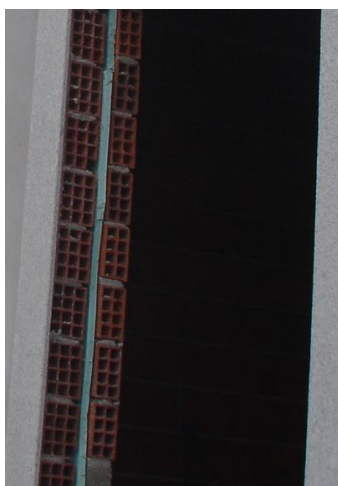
Pormenor construtivo da parede exterior, Seia
